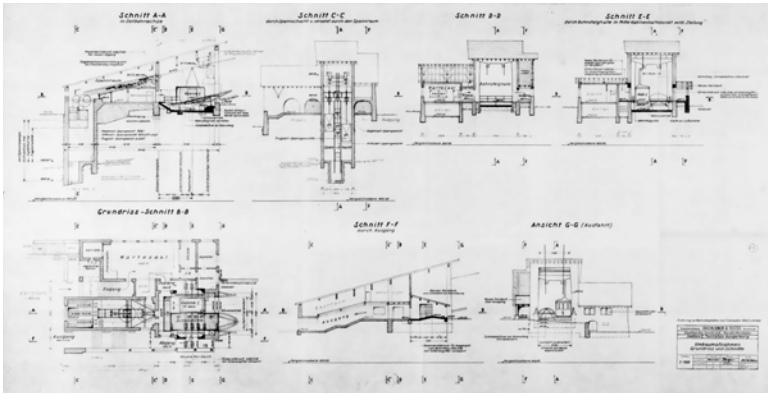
Franz Baumann, Talstation der Nordkettenbahnen, Innsbruck, Umbauplanung, Grundriss und Schnitt A–A in Seilbahnachse M 1:100, 1927/28; Lichtpause, Firmenstempel rechts unten, Zeichnungsnummer 22/694 a, datiert März 1959.
